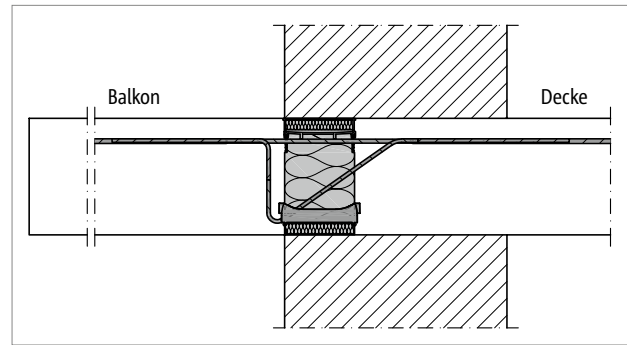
Schöck Isokorb® XT Typ KL: Anschluss bei einschaligem Mauerwerk
